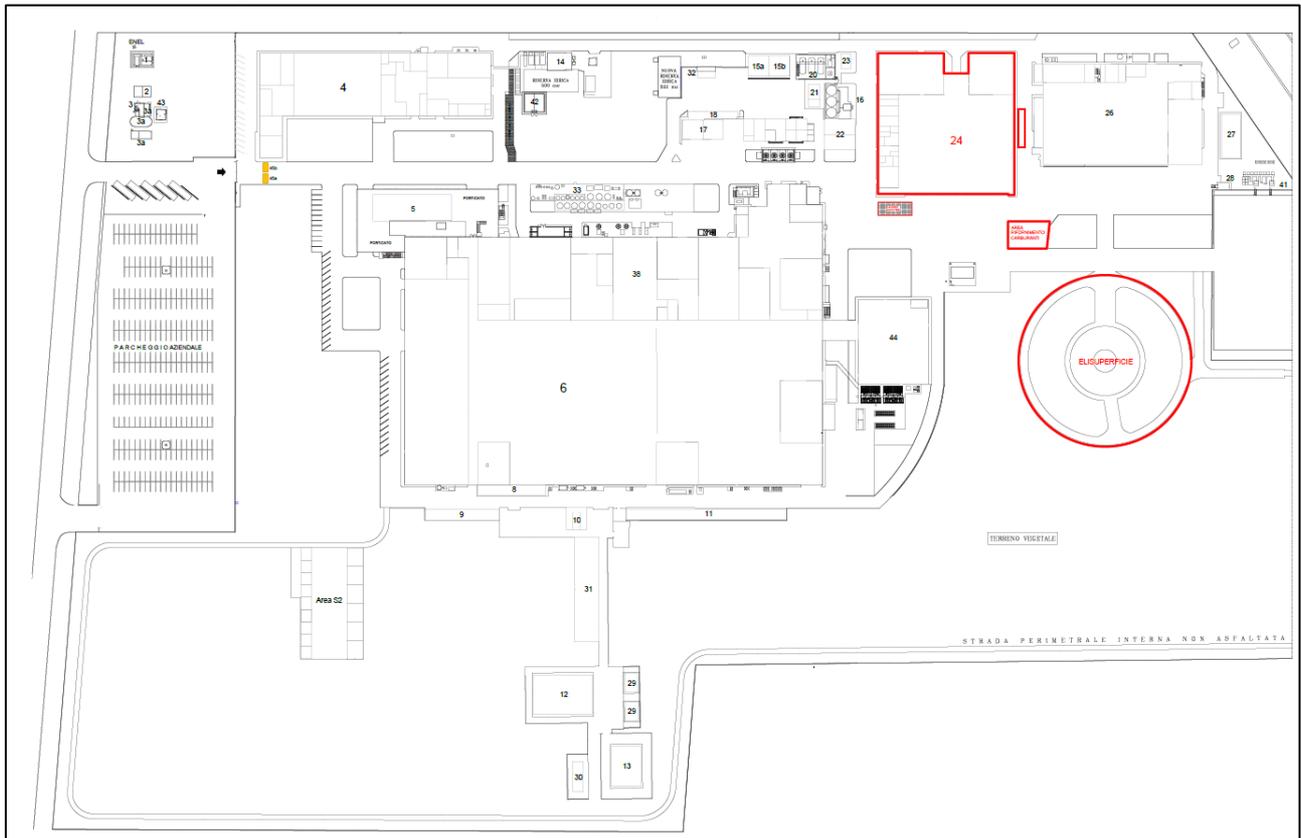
Planimetria stato di progetto stabilimento di Brindisi
